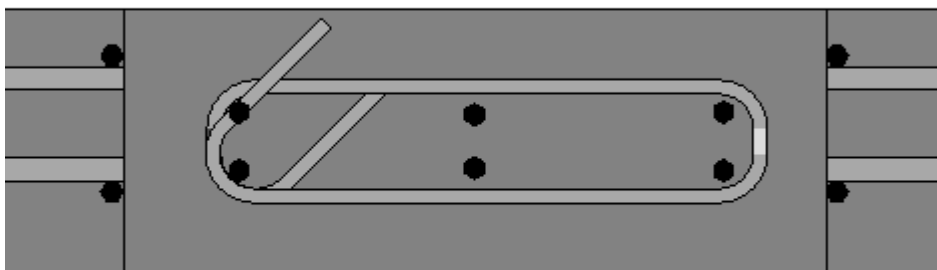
Vista Corte de Columna C-2 (Fuente: Elaboración Propia).
